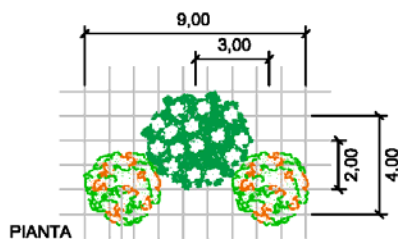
Sesti di impianto e legenda dell'intervento lungo le piste di cantiere
